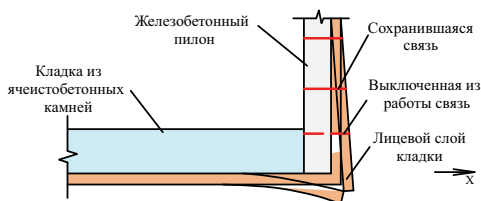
б. Горизонтальные перемещения на углу лицевого слоя, расположенного напротив кладки из ячеисто-бетонных камней по оси X на углу здания, после образования трещины на углу стены на всю высоту
